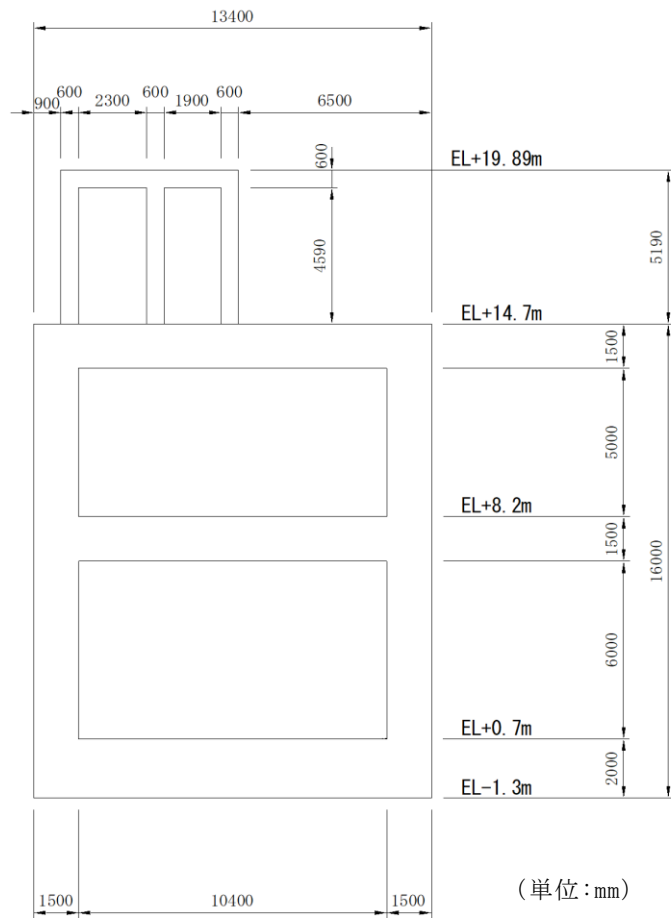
低圧原子炉代替注水ポンプ格納槽 断面図 (E-E断面)
